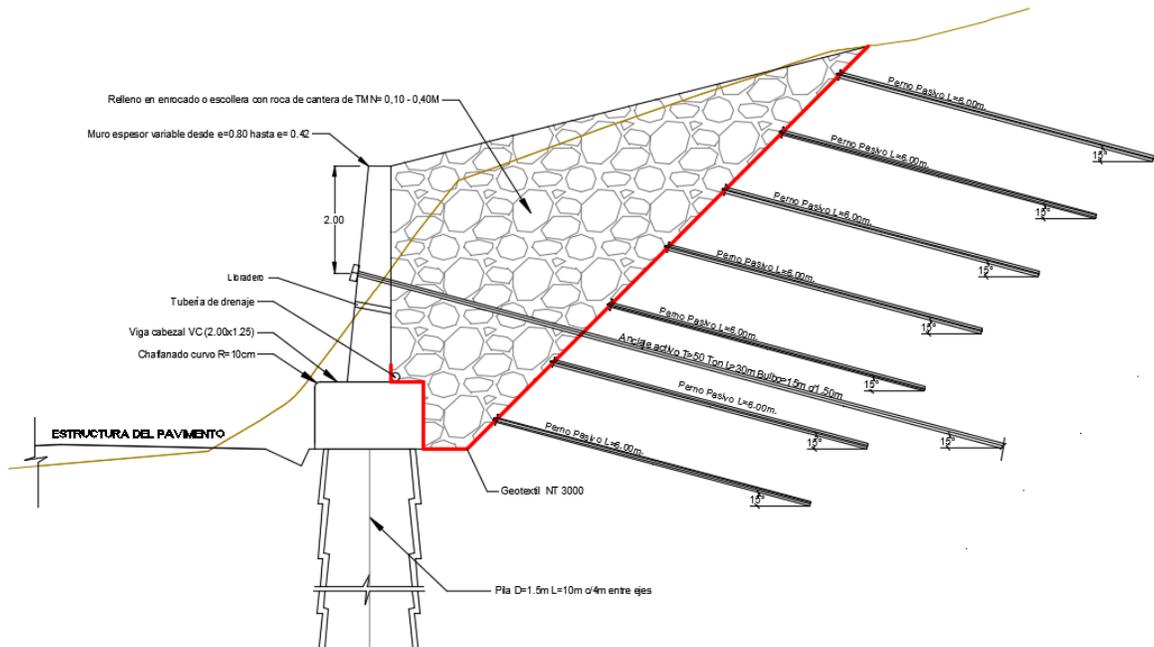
Detalles vista frontal y lateral anclajes Activos. Fuente: Diseños UT CONSULVIALES
